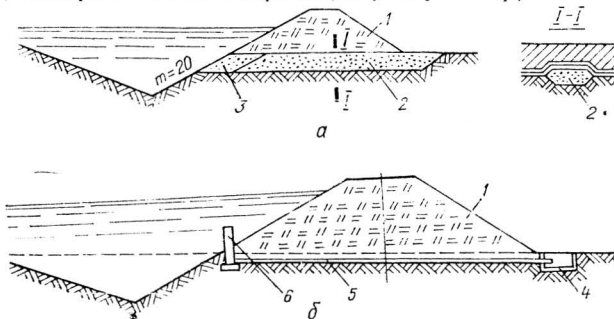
Валы-канавы с дренажем из щебня и песка (а) и в виде донного трубчатого водовыпуска (б):
